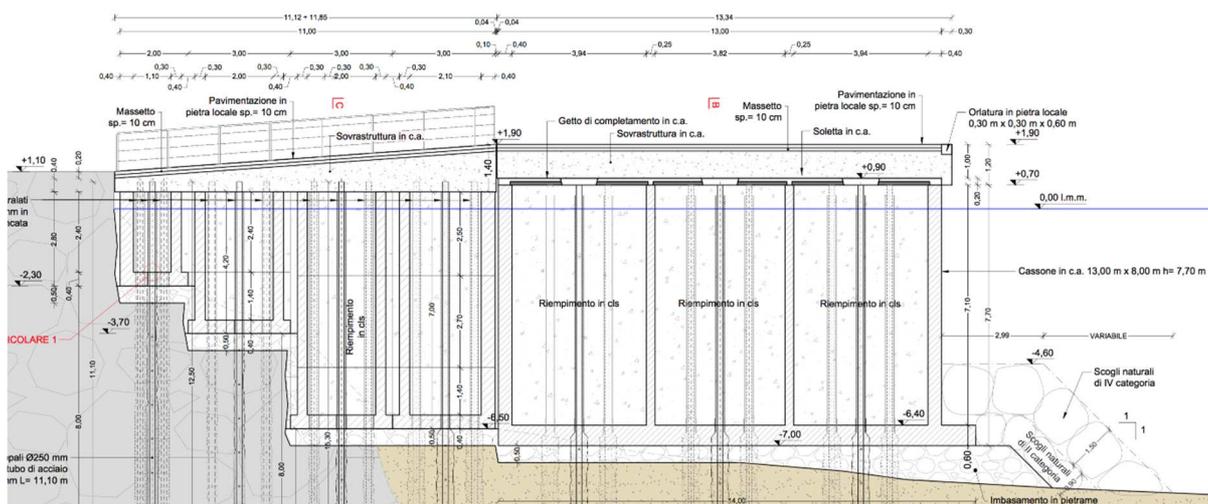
Soluzione del progetto definitivo sottoposto a valutazione migliorata in relazione alla quota di estradosso, che scende dalla $+2,50$ m s.l.m.m. alla $+1,90$ m s.l.m.m. (sezione verticale). Per mantenere la stessa impronta planimetrica è necessario fare ricorso ad una solidarizzazione al fondale tramite il ricorso a micropali (Alternativa 2).
